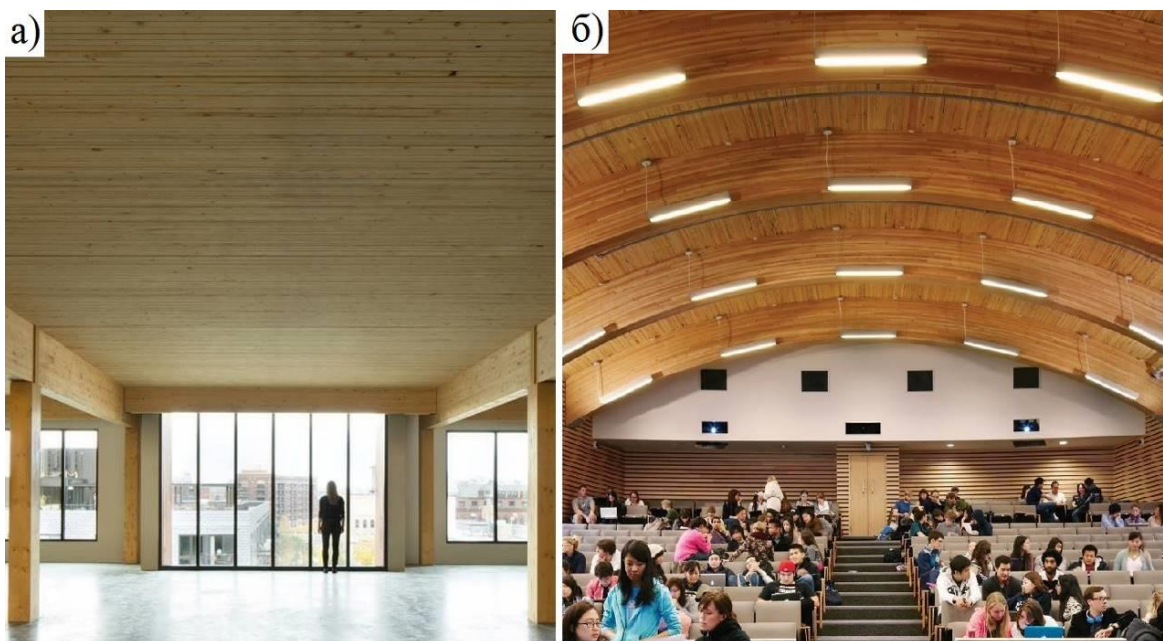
Деревоплита в общественных зданиях: а) перекрытие
